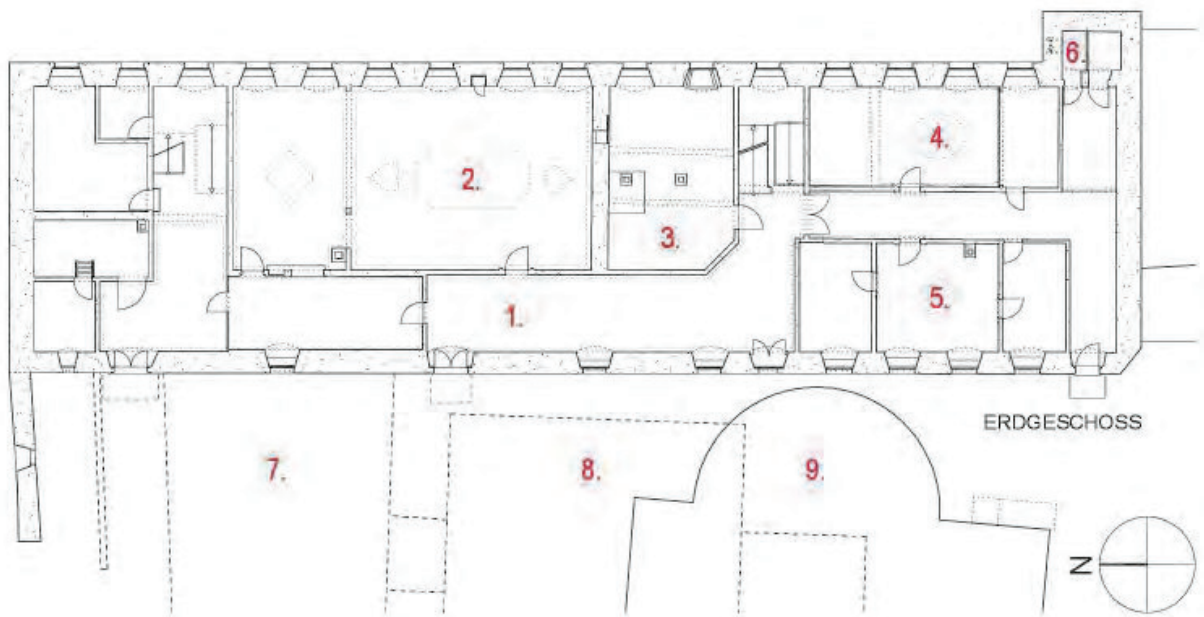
Aktueller Grundriss des Erdgeschosses mit Benennung von Raumnutzungen zur Klosterzeit: (1) Gang, (2) Konventsaal, (3) Klosterküche, (4) Provinzialat mit Nebenzimmern, (5) Beichtvaterstühle mit Nebenzimmern, (6) Abtritt, (7) ehemaliger Westflügel, (8) Vorgängerkirche, (9) Pfarrkirche St. Markus (Grundriss: Timo Raible 2018).
